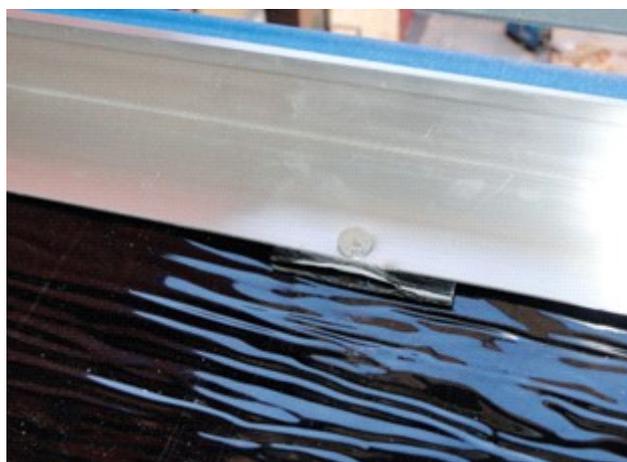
Un distanziatore (ad es. attraverso un fazzoletto di guaina autoadesiva ripiegato su se stesso) viene posizionato in corrispondenza di ogni fissaggio del profilo a T al fine di permettere il drenaggio e per aiutare a sigillare il foro dovuto alla presenza del collegamento.
